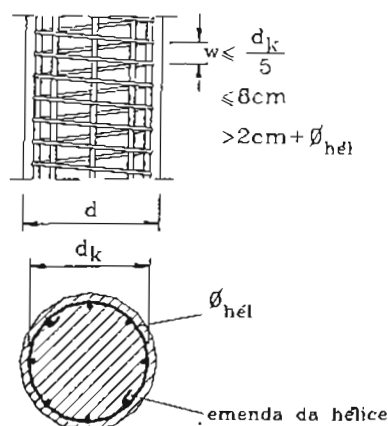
Detalhe de armadura para pilares cintados
